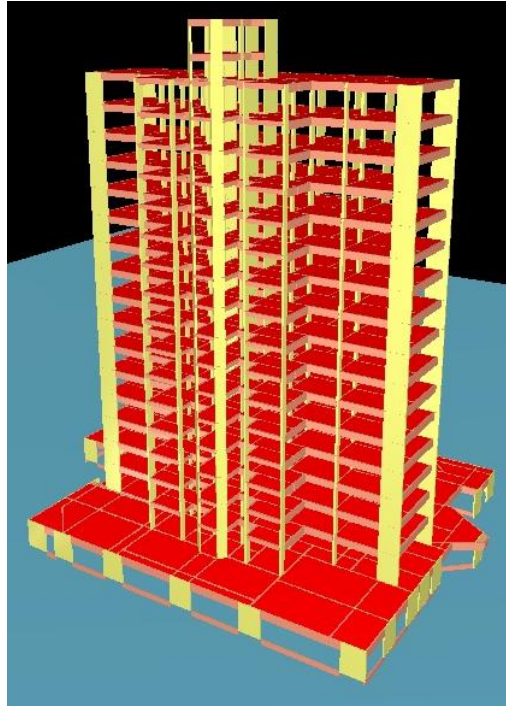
Projeto existente de estrutura de concreto (maquete TQS).
